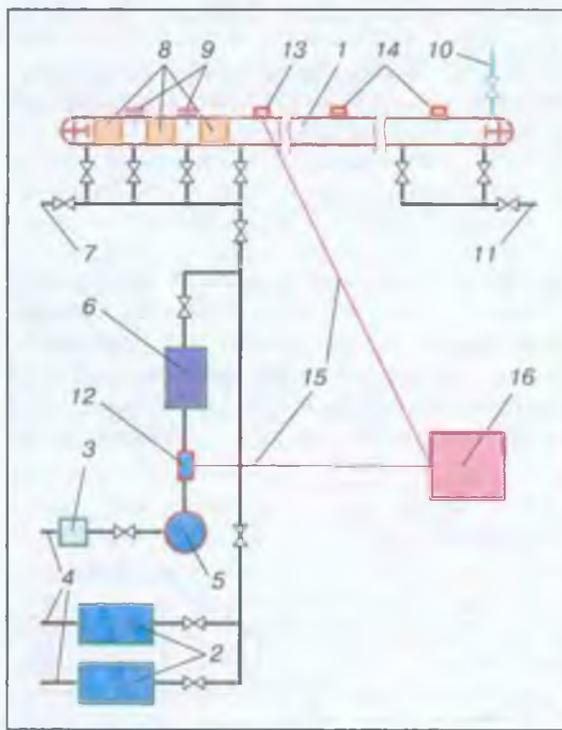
Принципиальная схема испытания участка газопровода методом стресс-теста: 1 – испытываемый трубопровод; 2 – наполнительный агрегат; 3 – насос низкого давления; 4 – всасывающий патрубок; 5 – резервуар для очистки воды; 6 – опрессовочный агрегат; 7 – шлейф от ресивера; 8 – очистной и разделительные поршни; 9 – стопорное устройство; 10 – свеча для выпуска воздуха; 11 – сливной (перепускной) трубопровод; 12 – блок измерения расхода воды (высокоточный сенсор расхода, датчик темп-ры, преобразователь сигналов); 13 – блок измерения давления (высокоточный датчик давления, датчик темп-ры); 14 – контрольный датчик давления и датчик темп-ры; 15 – кабельные линии; 16 – блок обработки результатов измерений (контроллер, компьютер).
